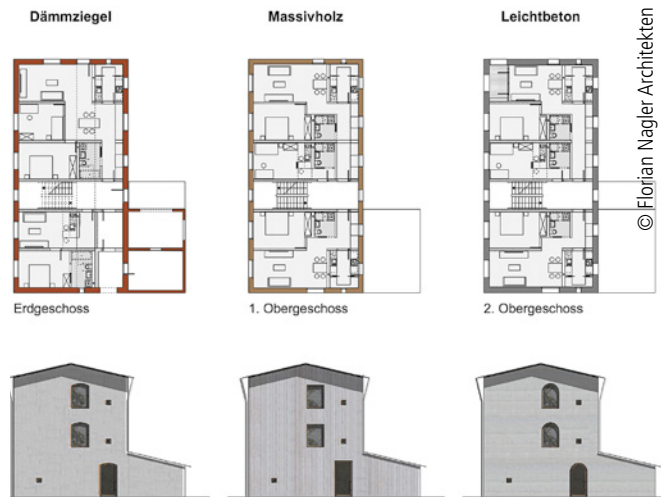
Grundrisse und Straßenansicht der drei Forschungshäuser
